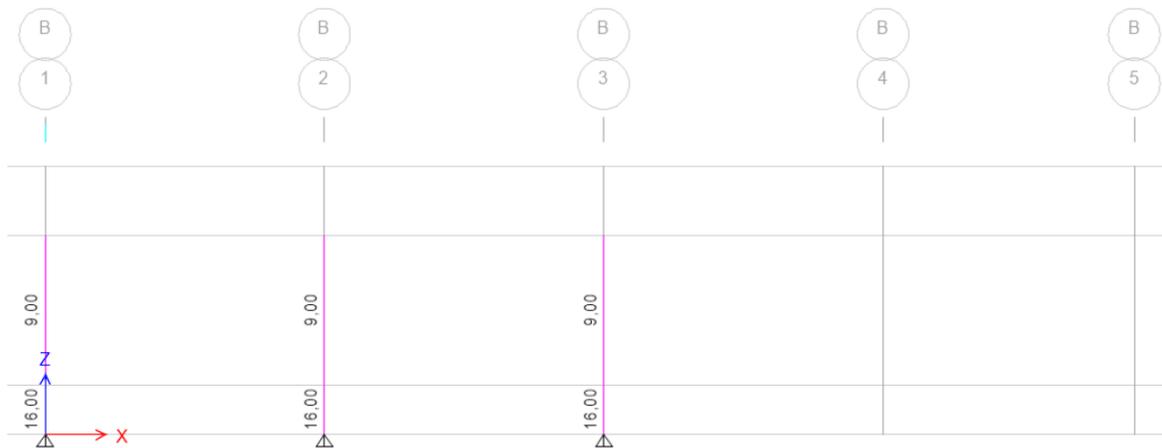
Acero requerido por columnas, pedestales y vigas del eje B (en cm<sup>2</sup>)
